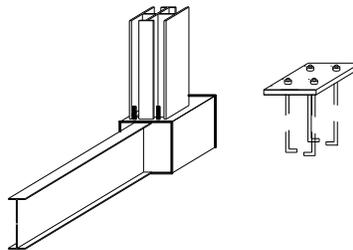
, Detalle columna en dado, placa de acero. Diseño: Hugo Orduña.
